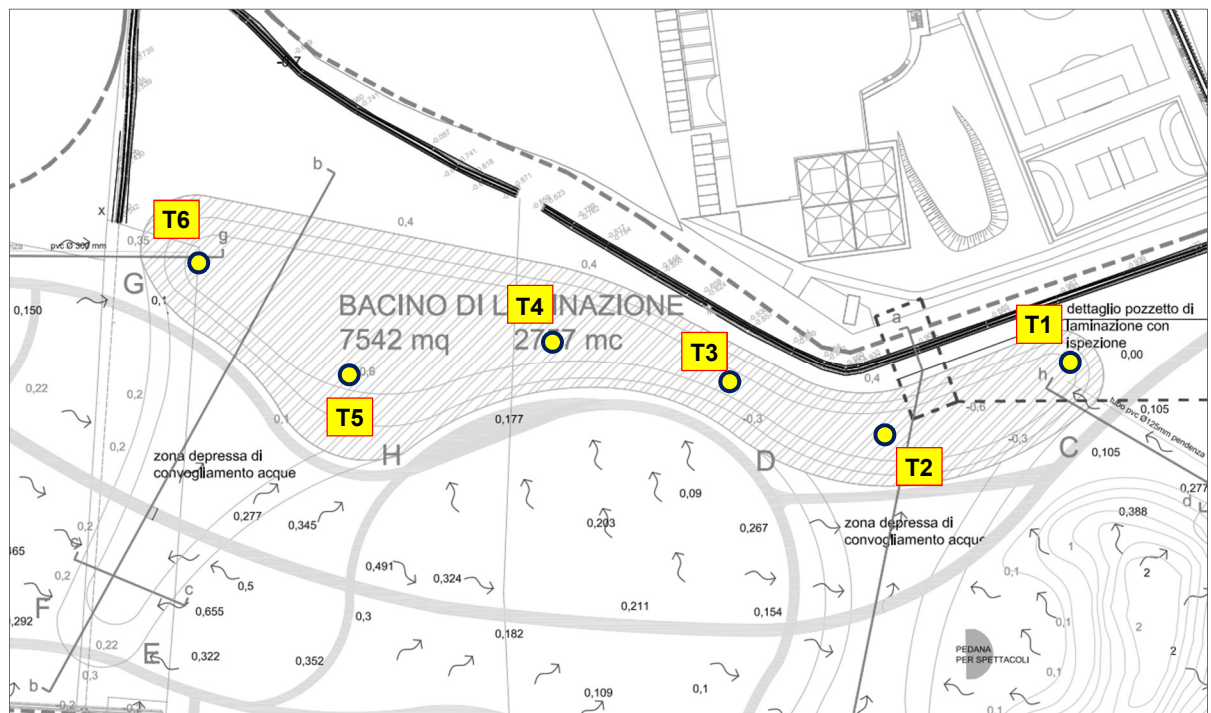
Planimetria di progetto con ubicazione indicativa degli scavi eseguiti
